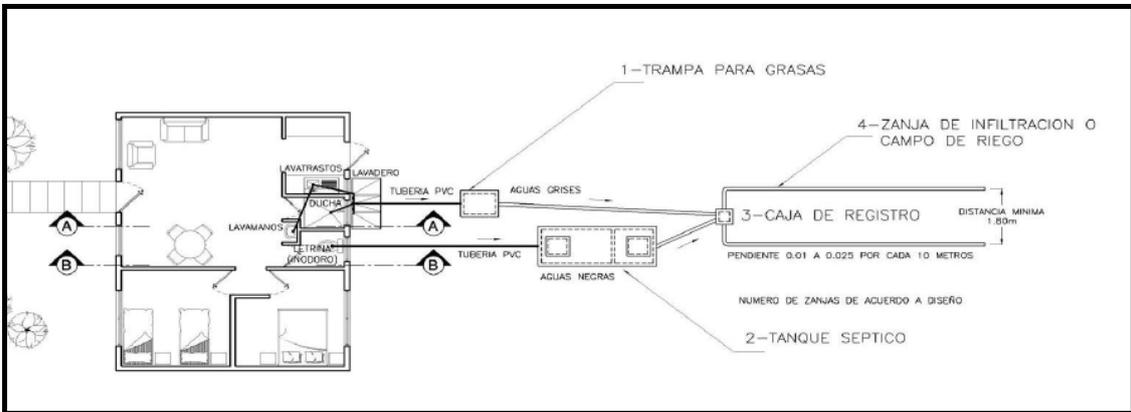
ubicación en planta de tanque séptico y zanja de infiltración
